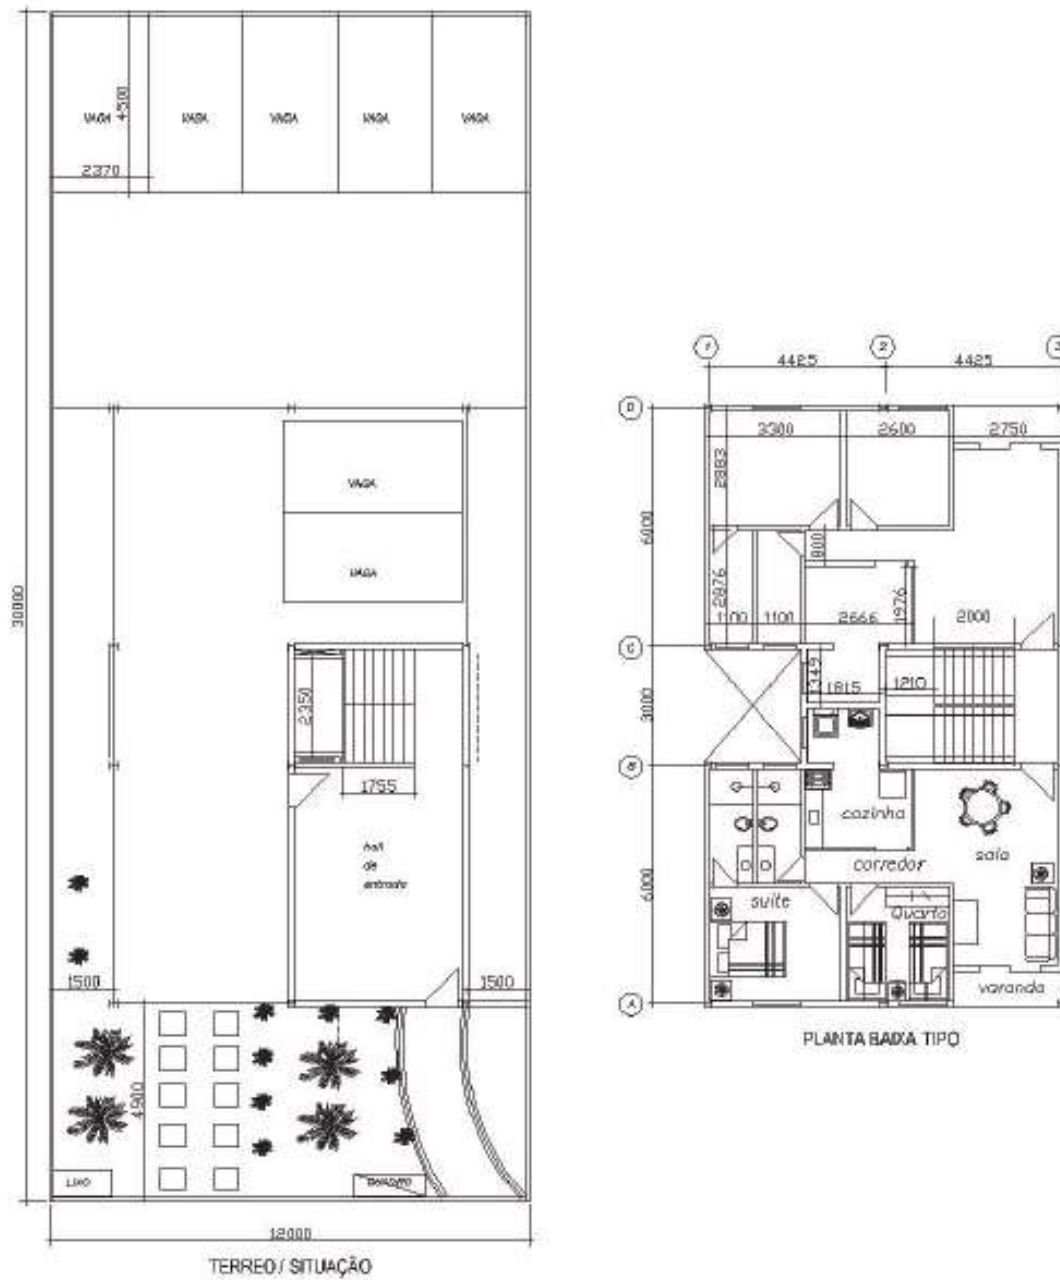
Planta de situação e pavimento tipo. Fonte: INSTITUTO AÇO BRASIL et al., 2011.
